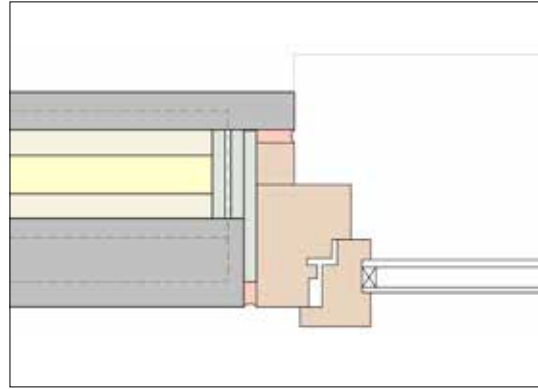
Fassaden-Sandwichelemente (FSE), Einbindung Fenster (kbp)
